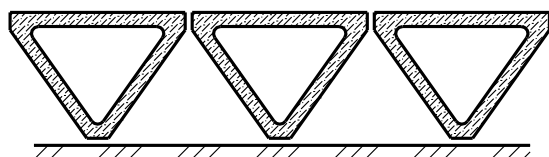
Поперечное сечение перекрытия из сборных плит полого треугольного сечения
